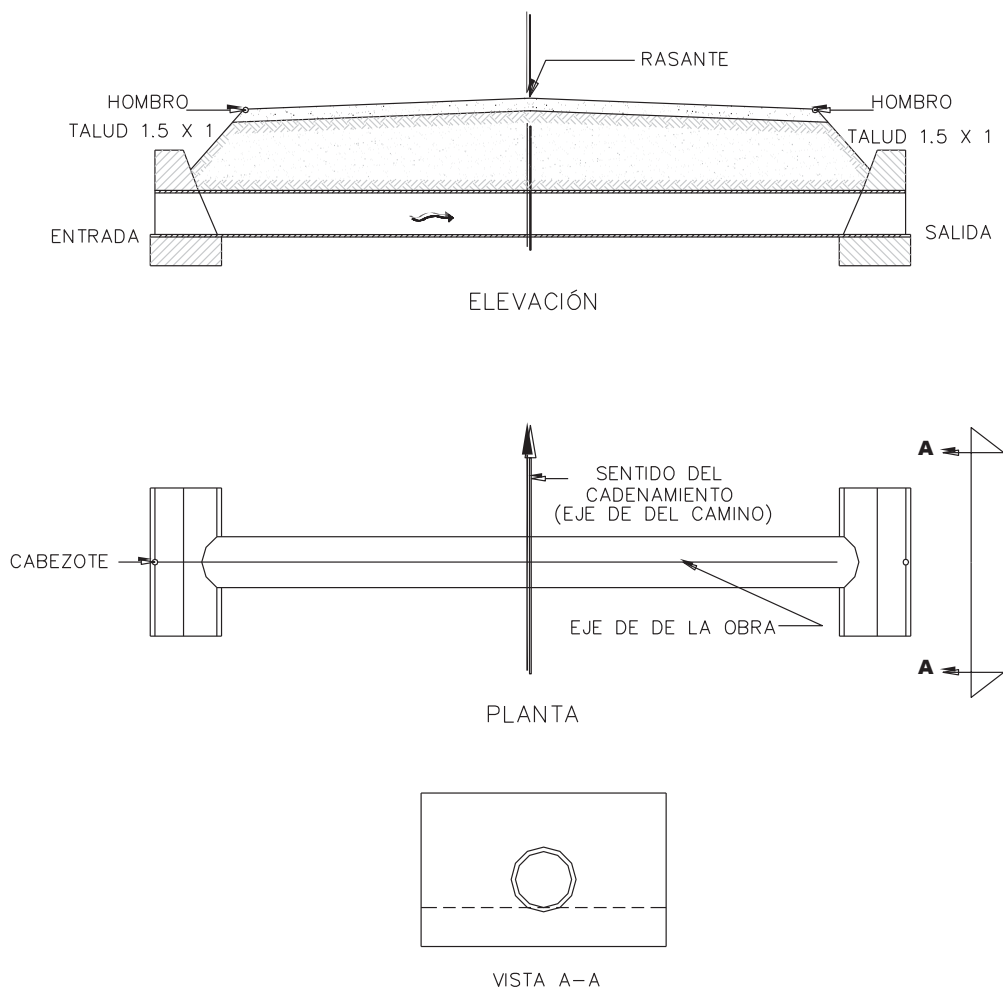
Alcantarilla de tubo con doble muro de cabeza.
